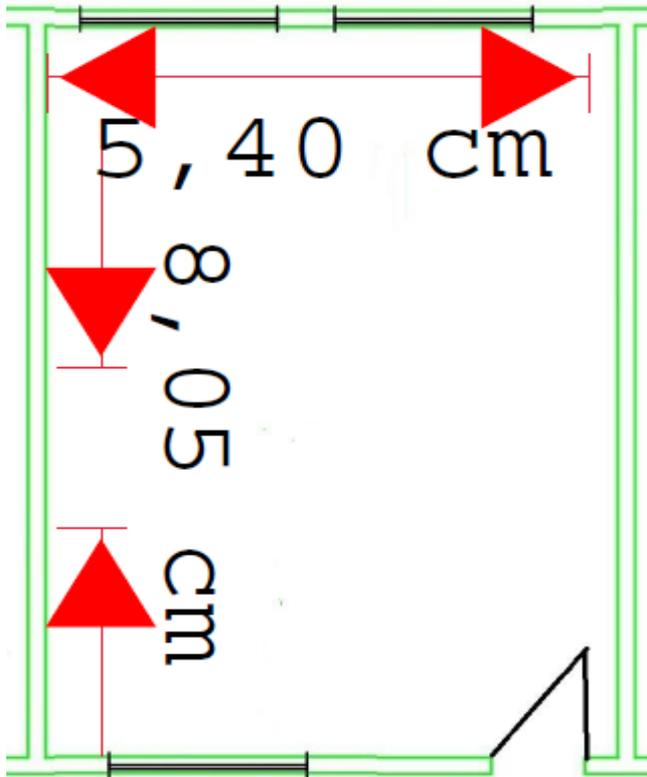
Planta baixa do Arquivo Inativo sala nº15 do CNPMF-EMBRAPA
